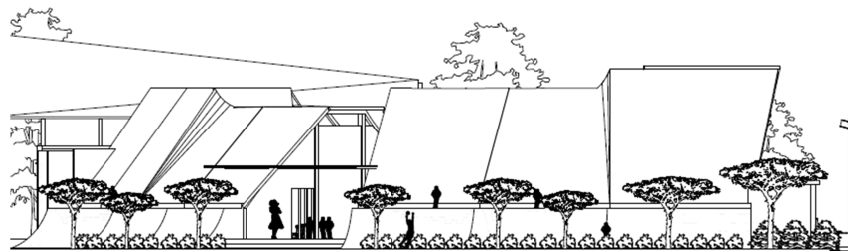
3D Tampak Selatan Massa Bangunan Kedua
